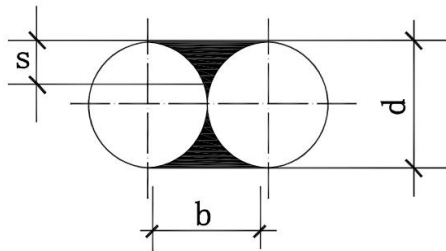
搭接焊接头的焊缝尺寸示意图
